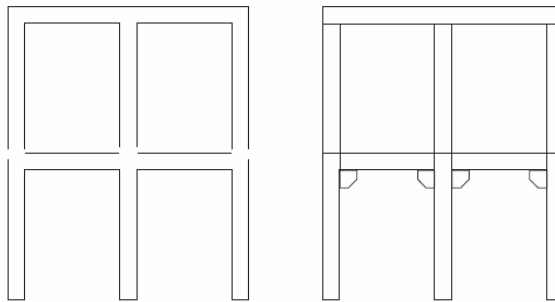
Esquema de Portico y Sistema Pilar- Dintel.
